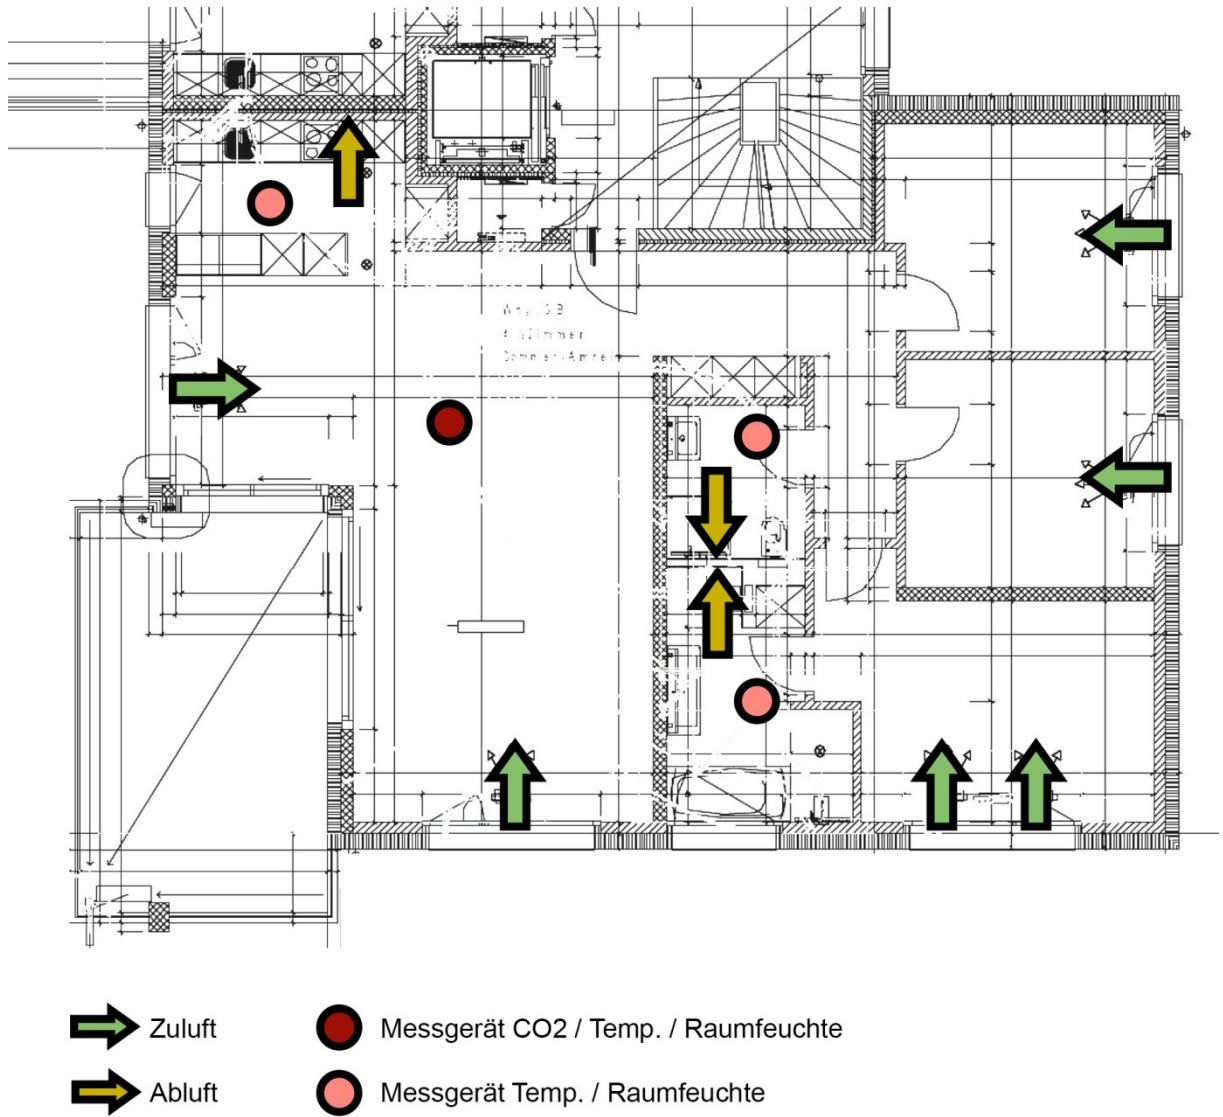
MFH Malters: Grundriss Wohnung D
